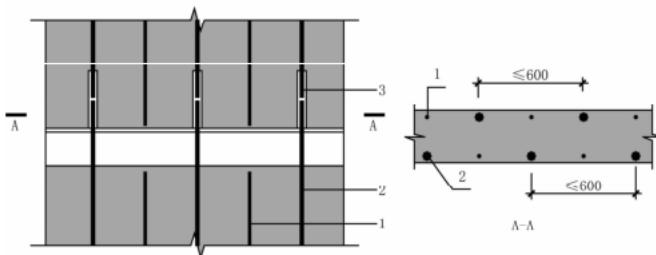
预制剪力墙竖向分布钢筋连接构造示意
